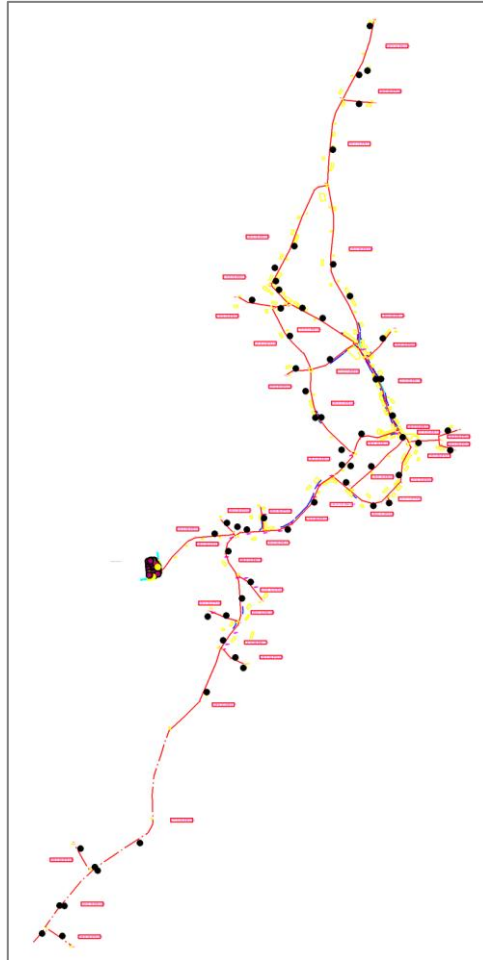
Planta da rede de abastecimento de águas de Maçóida
